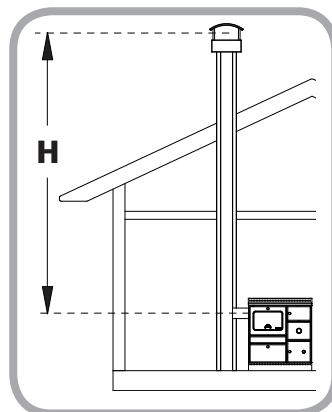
Dimension H pour le dimensionnement du conduit de fumées
